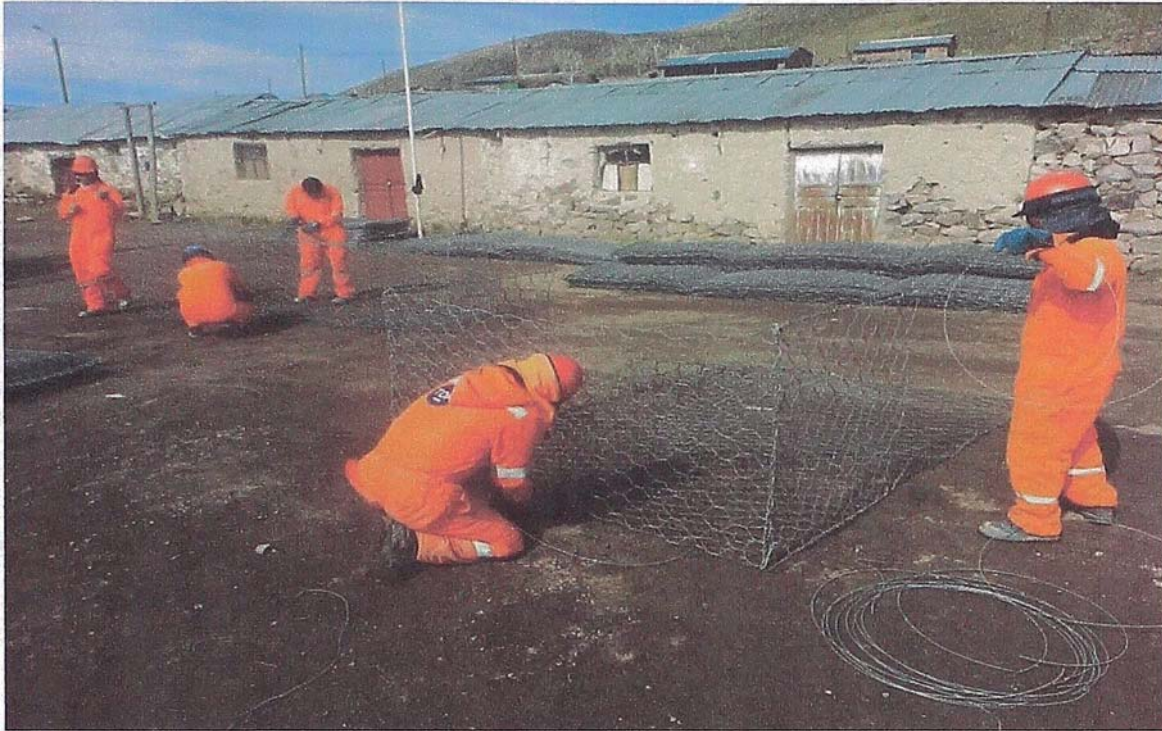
Armado de Gaviones en Terreno Plano
